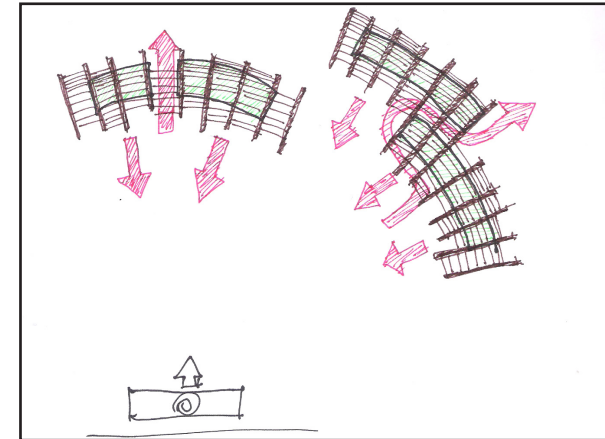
Croquis de la disposición en planta de los volúmenes. Fuente: del Autor.
